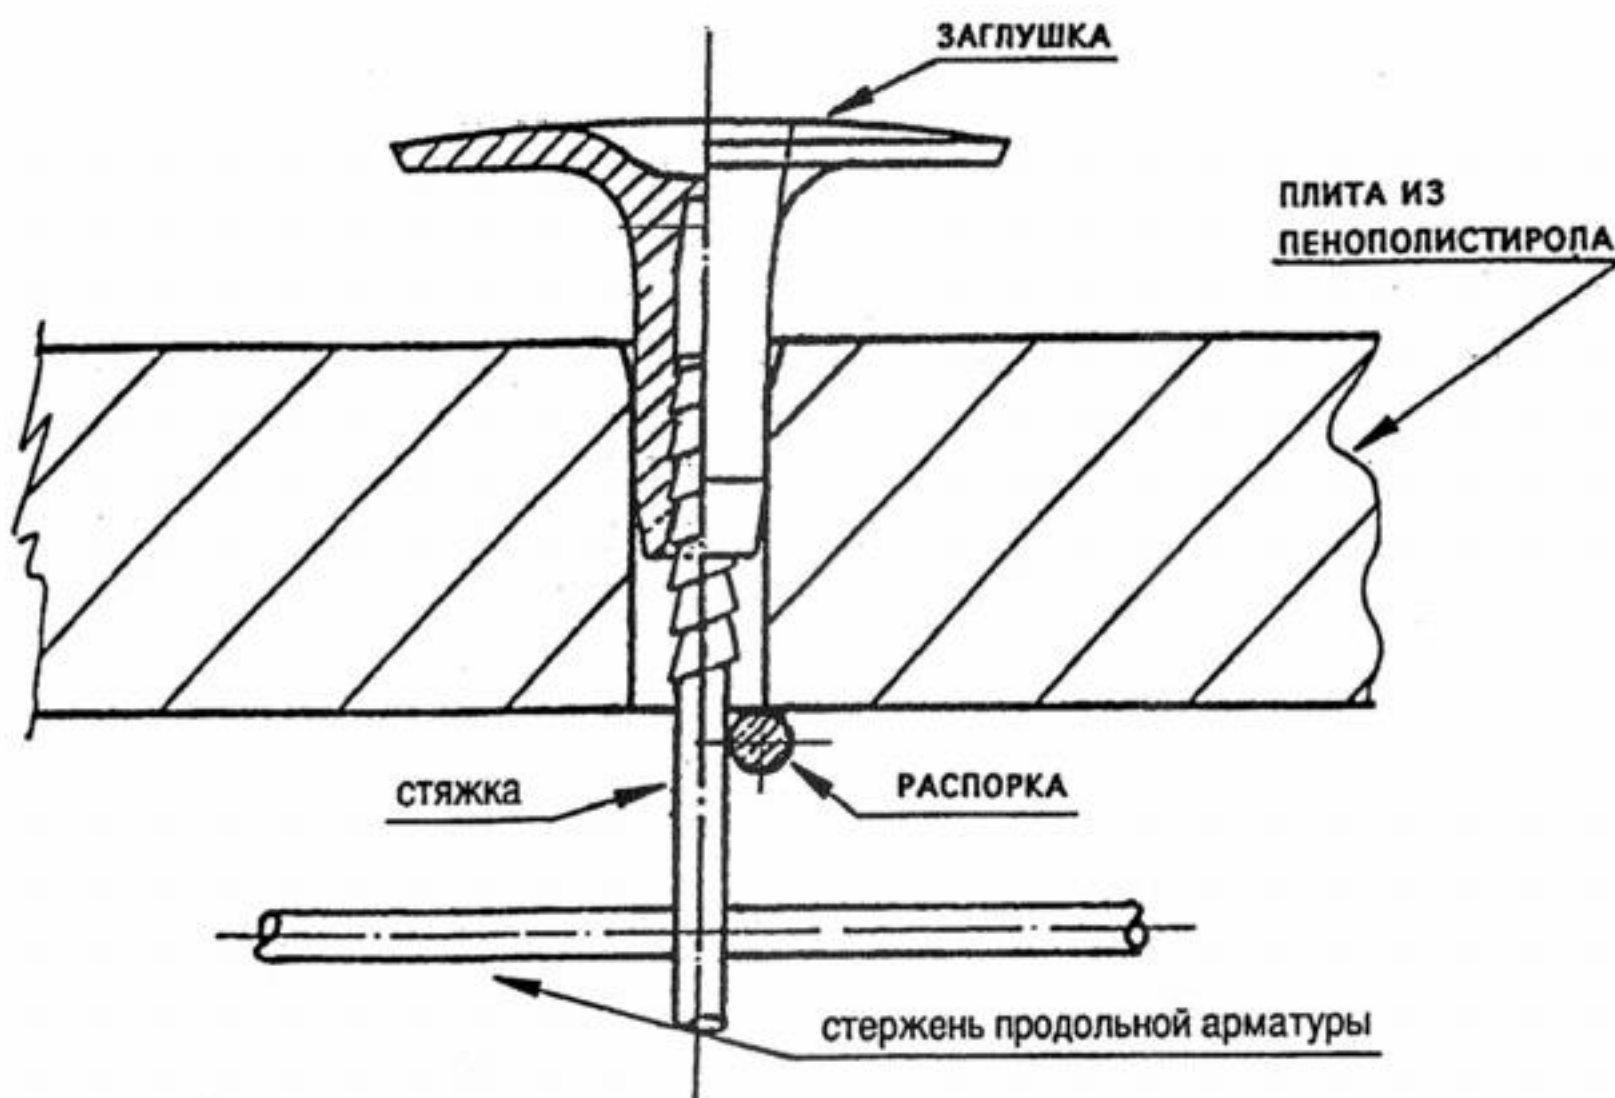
Деталь установки заглушки элемента опалубочного наружной стены
